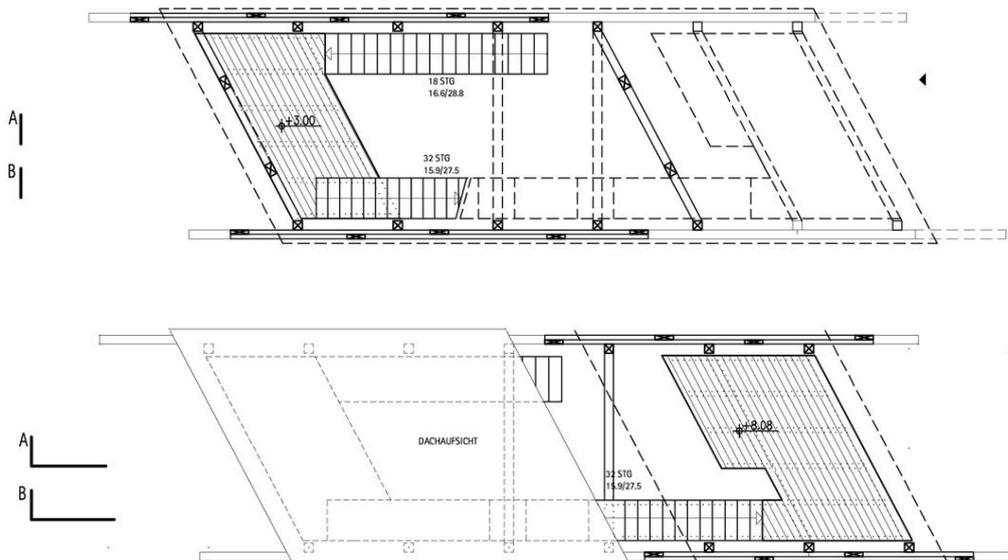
Sección Planta primera y segunda. Fuente: plataformaarquitectura.cl/cl/02-16403/torre-de-observacion-de-aves-gmp-architekten
